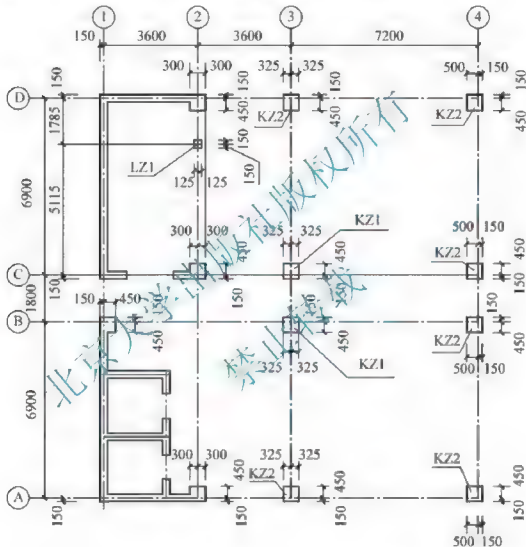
某办公楼二层 4.270~8.470m 柱平法施工图
